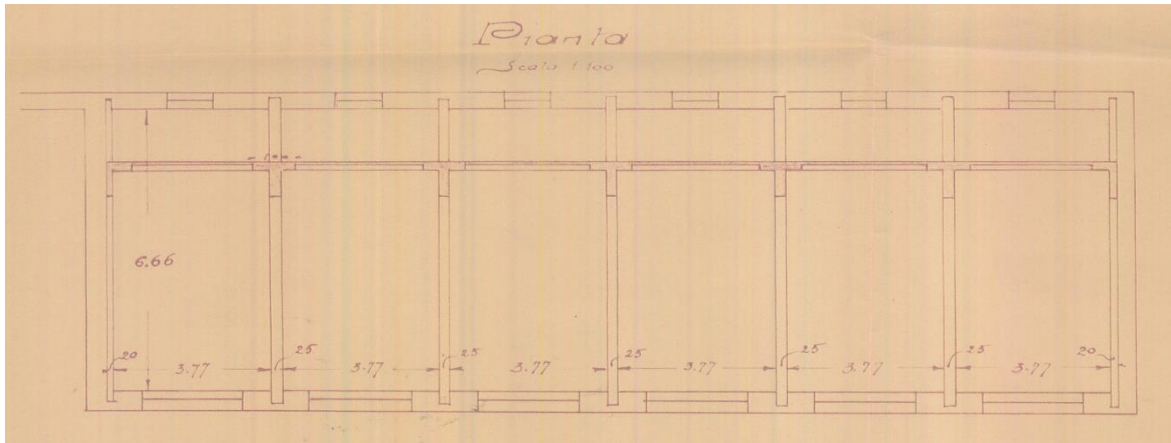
Pianta dell'intervento di rifacimento del solaio nel corpo C
